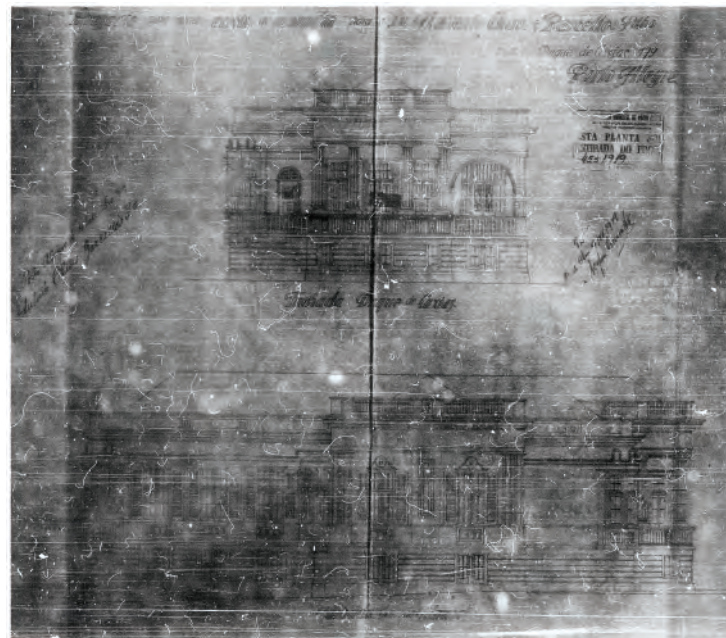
Fachada Norte (Rua Duque de Caxias) e fachada Leste (Rua Gen. João Manoel). FONTE: Acervo do Arquivo Público Municipal de Porto Alegre.
